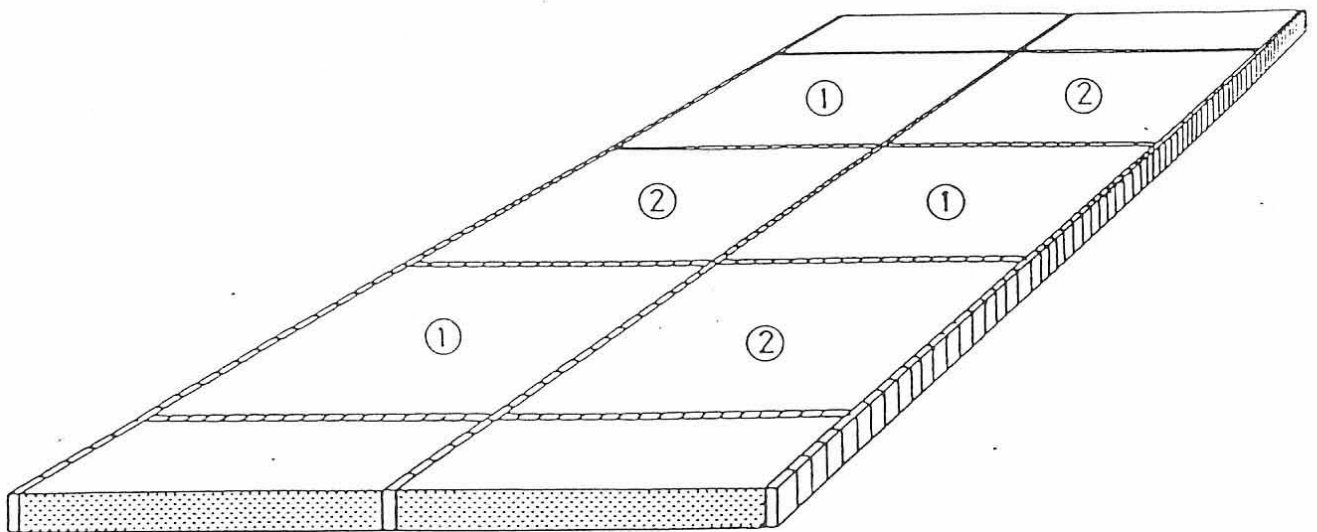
Esquema de construcció d'un paviment per lloses alternes.
